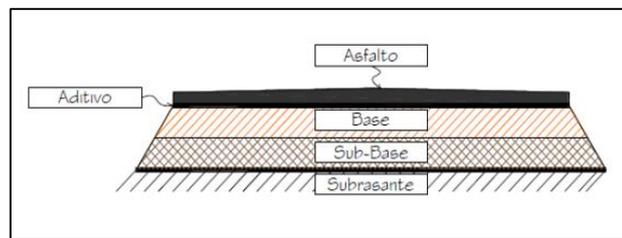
Sección Típica Transversal Pavimento Semirrígido
